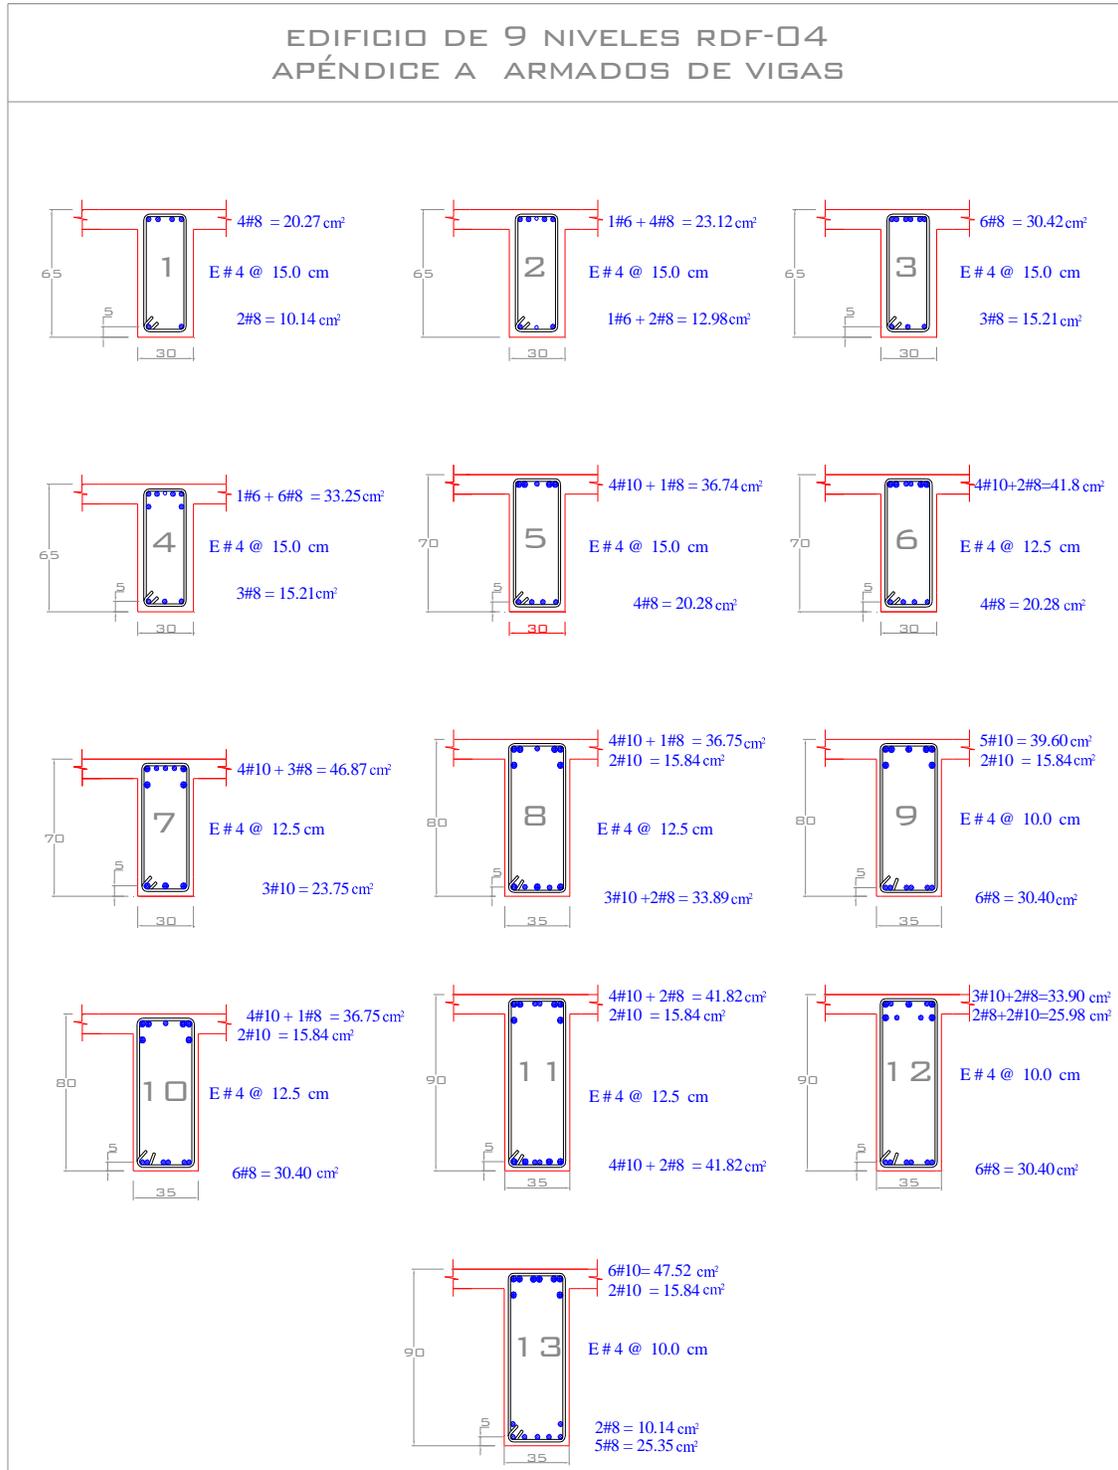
Armados longitudinal y transversal propuestos de las vigas del eje C, edificio 9 niveles, Apéndice A (caso B) de las NTC-Sismo, RDF-04
